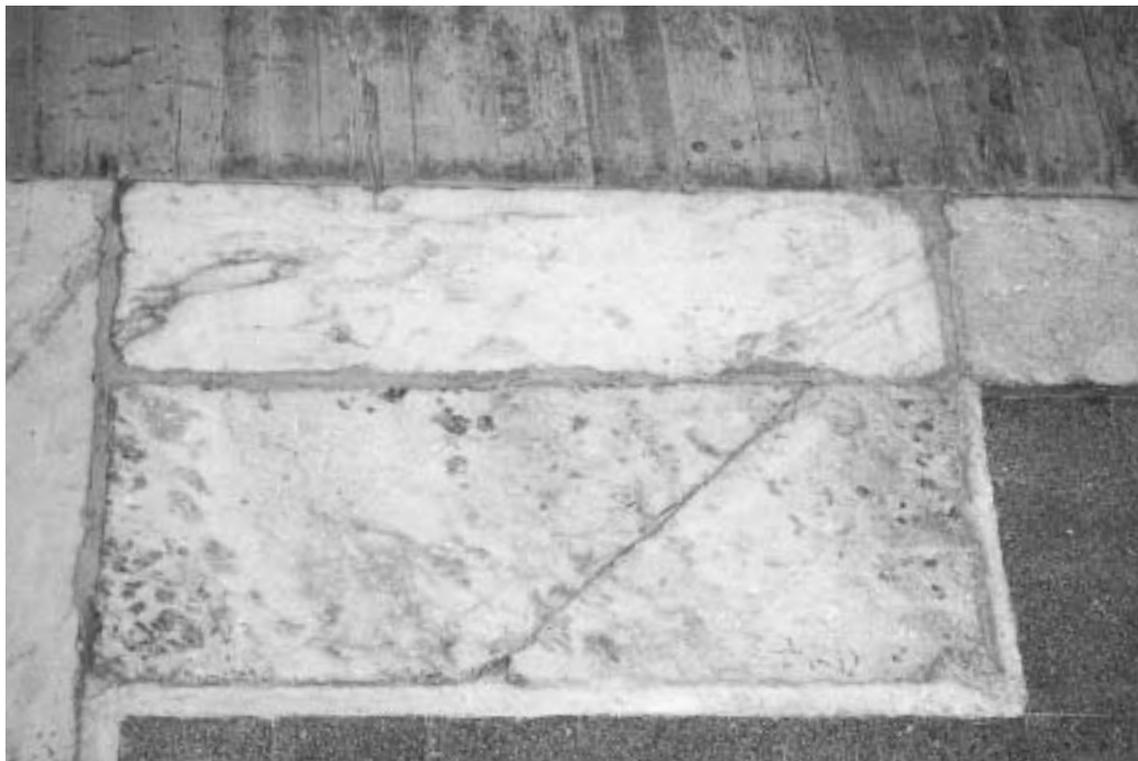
Pormenor dos diferentes tipos de pavimentos existentes.
